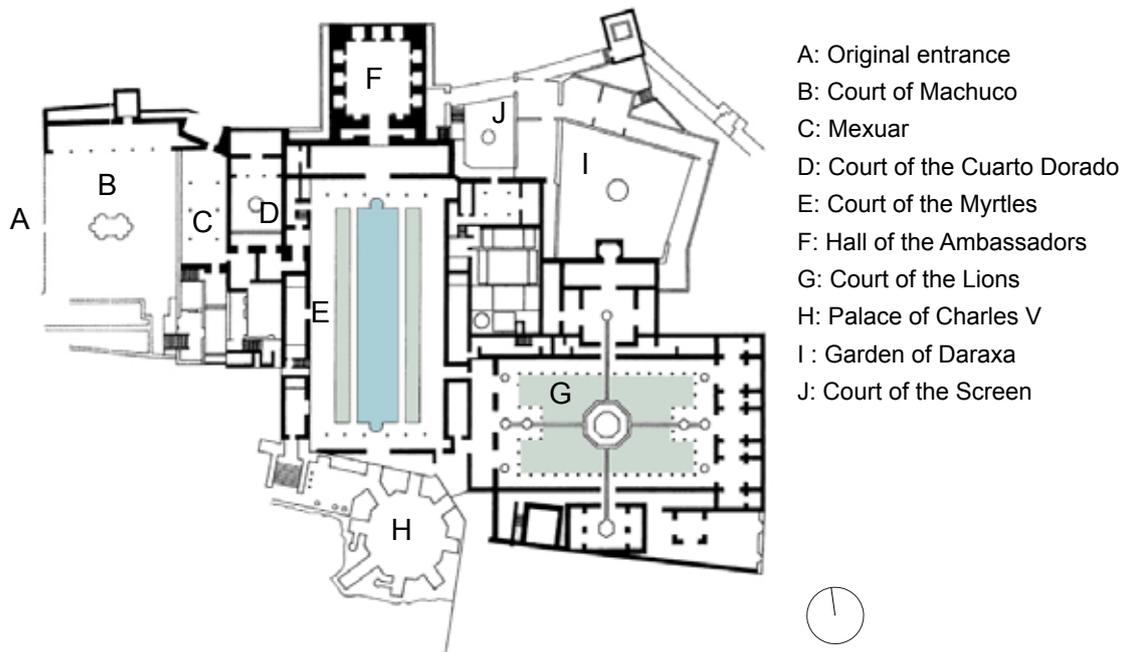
Grundriss des Alhambra Palasts in Spanien.
